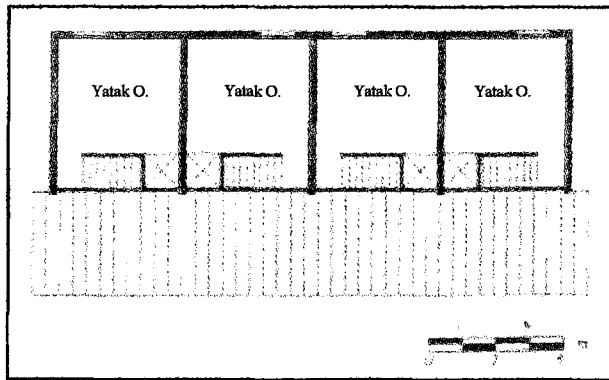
İki yatak odalı göçmen evi planı tip-2 (Keleş, 1998).
